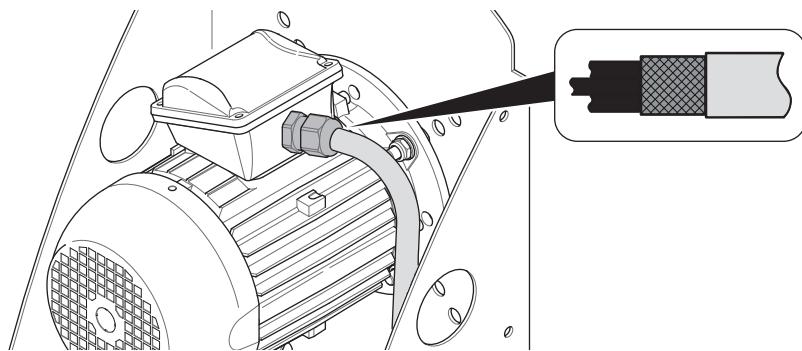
Princip připojení krátkého kabelu motoru (FM v blízkosti ventilátoru)
